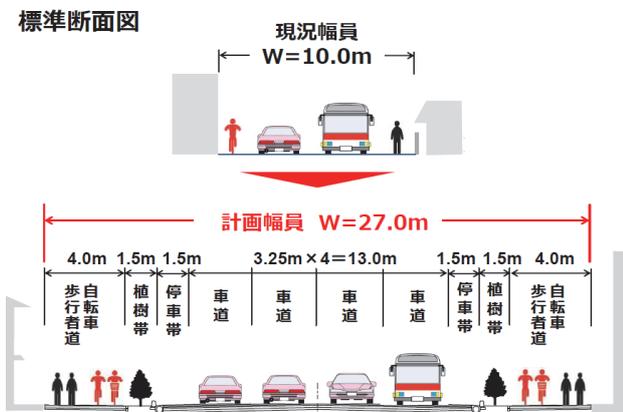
都市計画道路益城中央線の標準断面図（文献 8）より引用）
